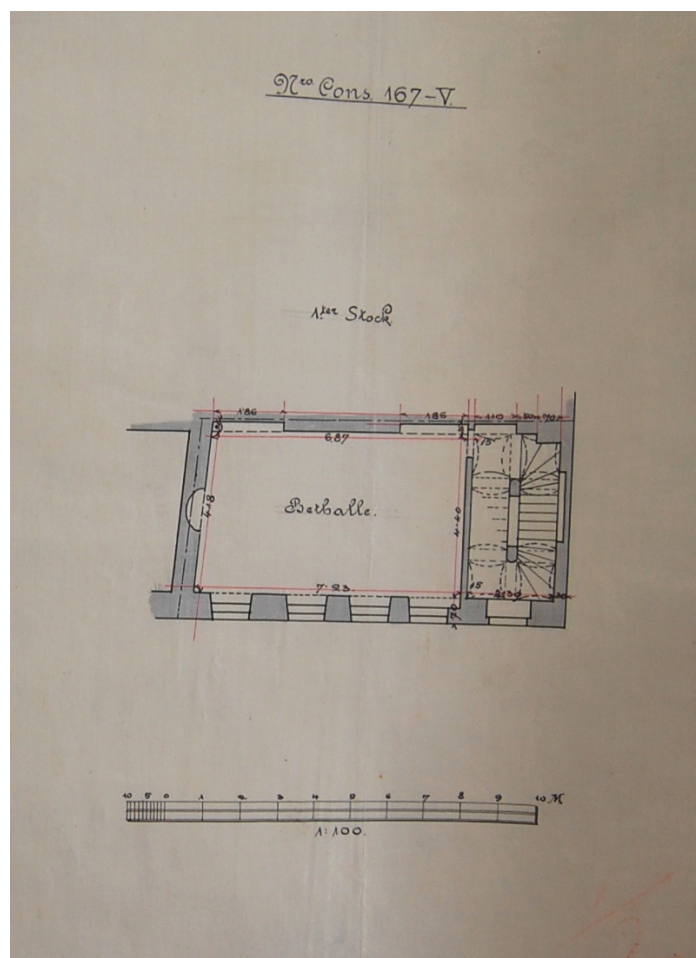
Grundriss der Popper-Moscheles-Betstube.
